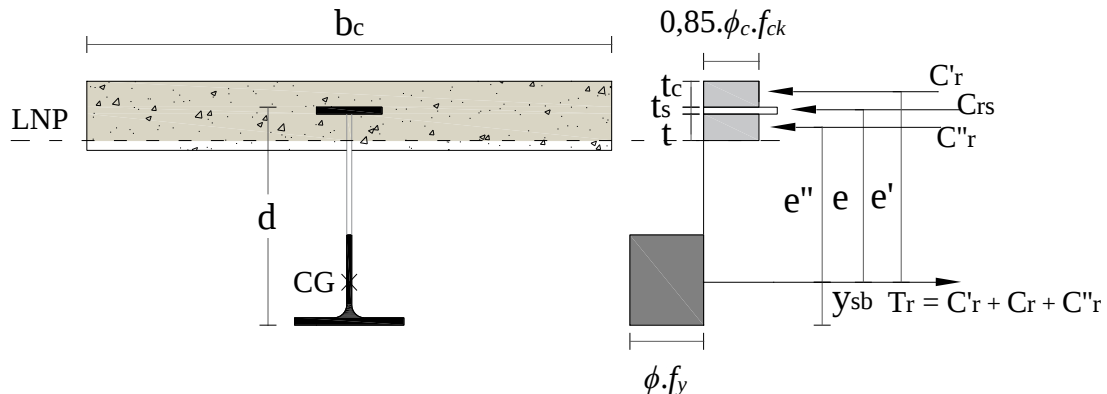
Modelo de cálculo com linha neutra plástica sobre o concreto abaixo da mesa do perfil metálico
